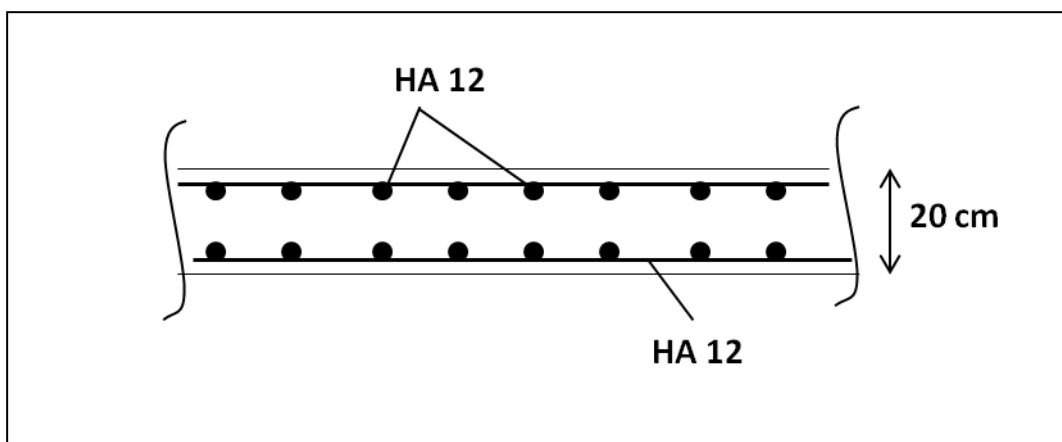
Schéma de ferrailage de la dalle pleine
